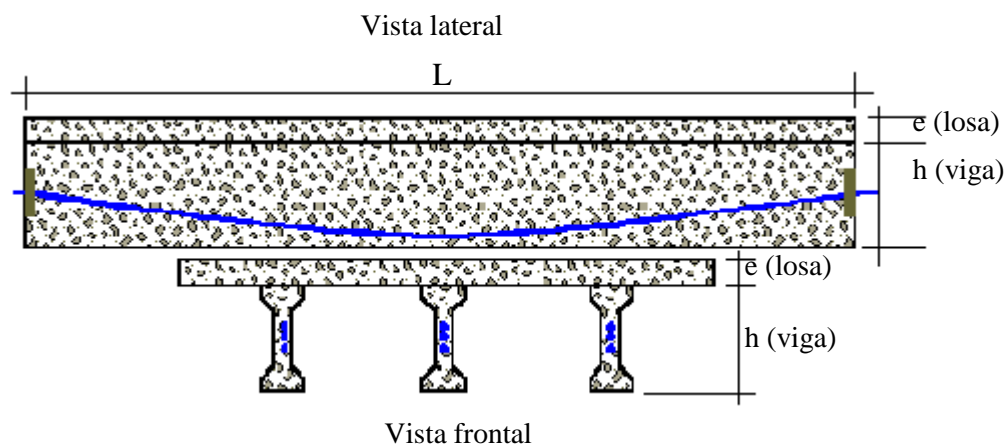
Puente con Vigas de Concreto Postensado.
